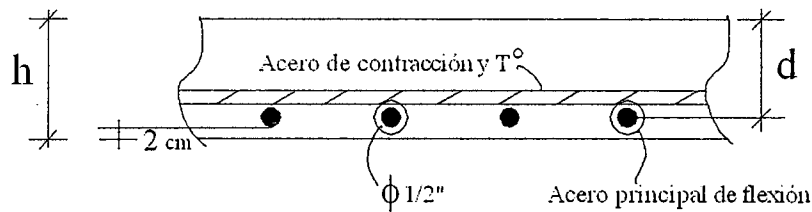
Peralte efectivo en una losa maciza armada en una dirección.
